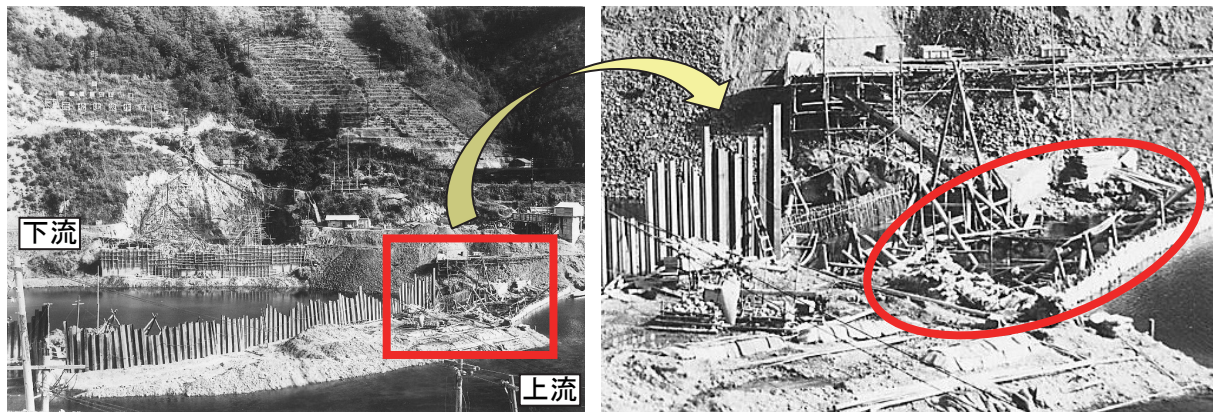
上流側締切コンクリート部の状況 (牛枠設置)
